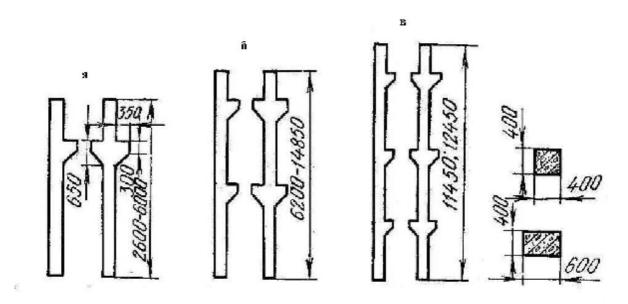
Колонны (а – в один этаж со стыками; б – двухэтажной высоты; в – трёхэтажной высоты)
